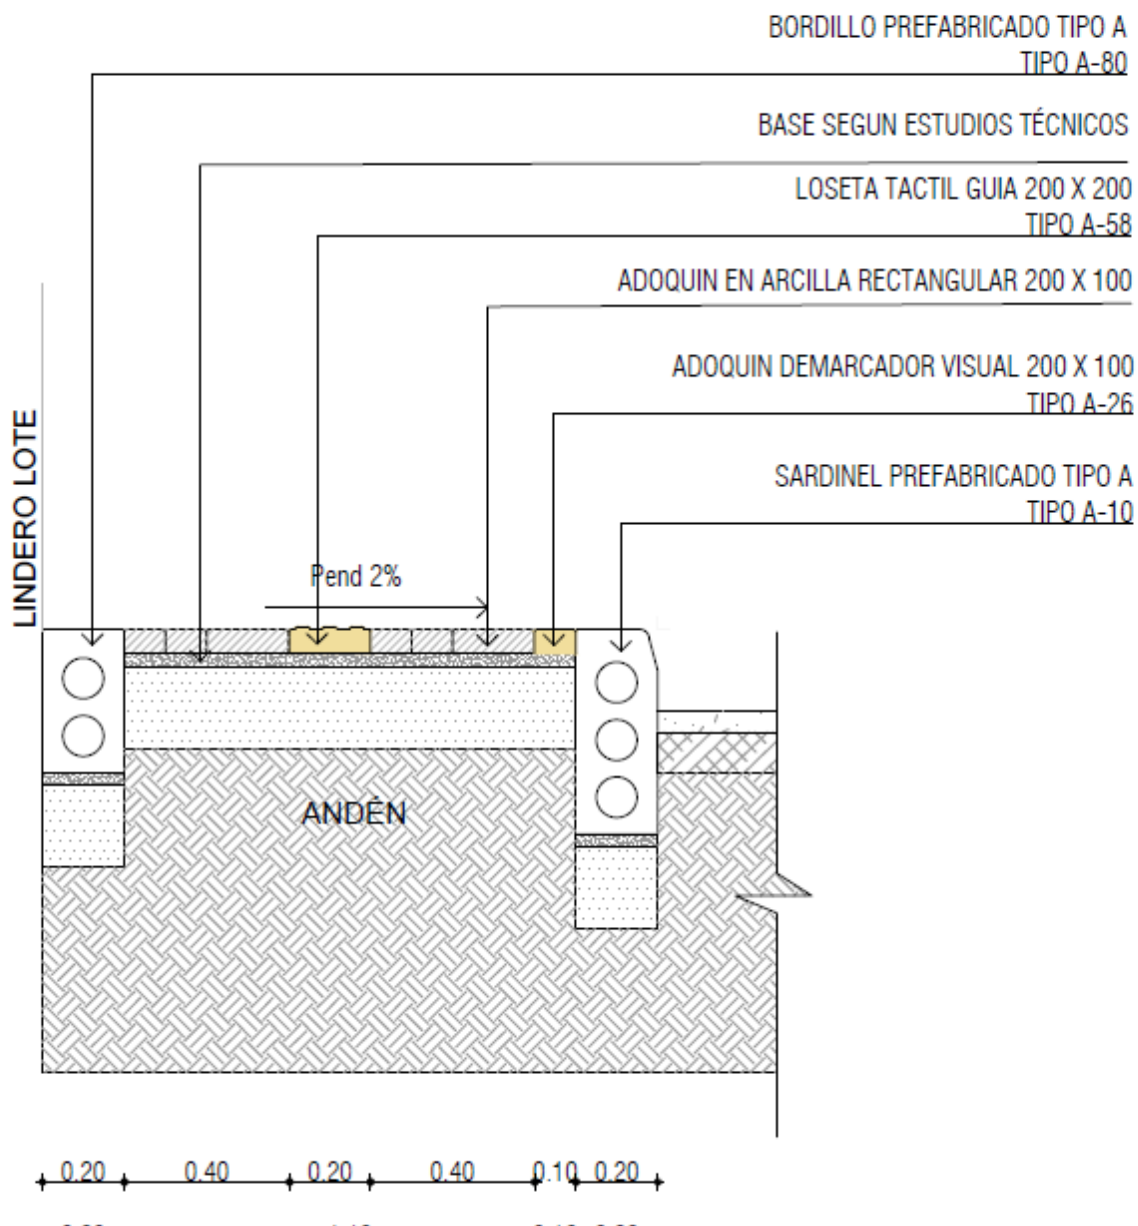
Diseño andén base 1.5mts y doble 2.10mts planta.
